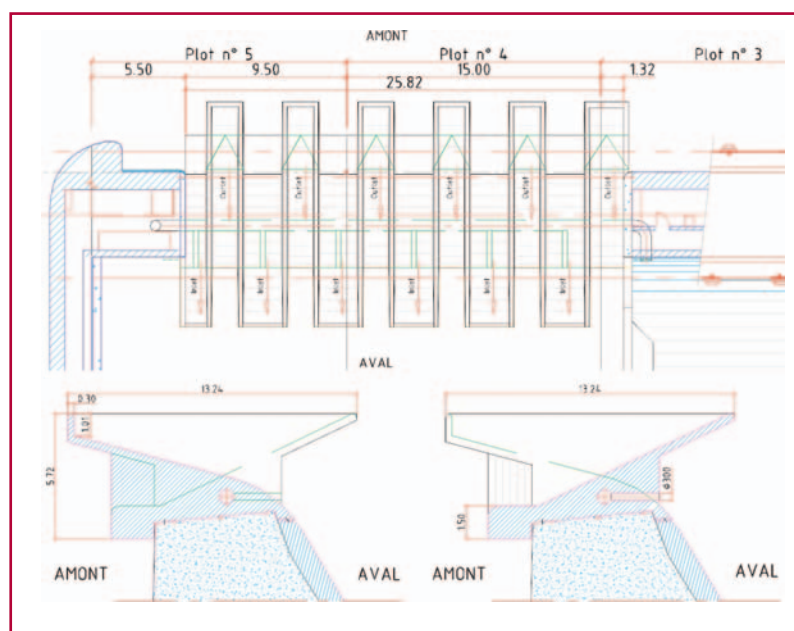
Presa de La Raviège. Planta y secciones del aliviadero auxiliar tipo PKW.
